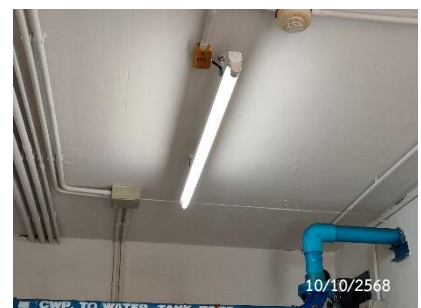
สระว่ายน้ำของโครงการ (ต่อ)
